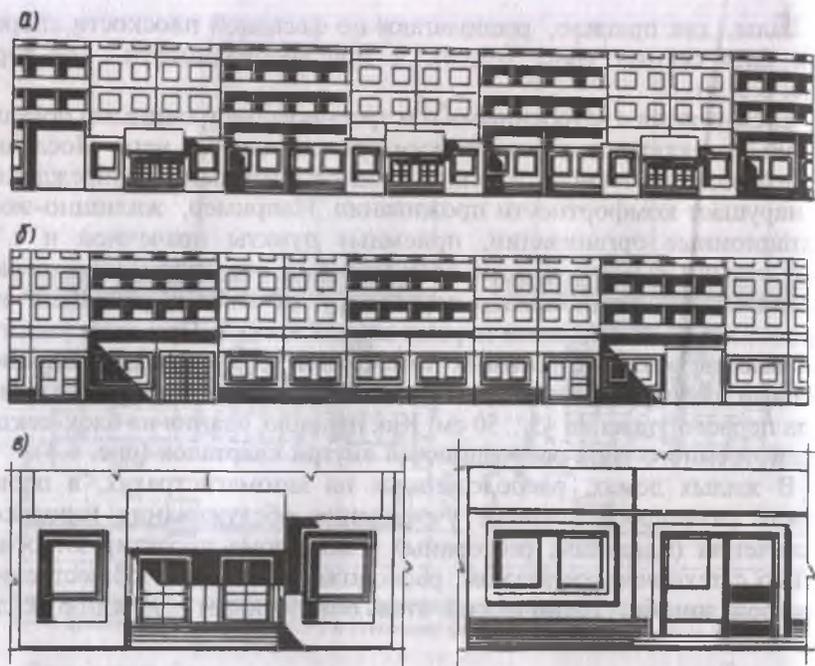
Фасады жилых домов в бескаркасных конструкциях с нежилыми первыми этажами для застройки магистралей:
